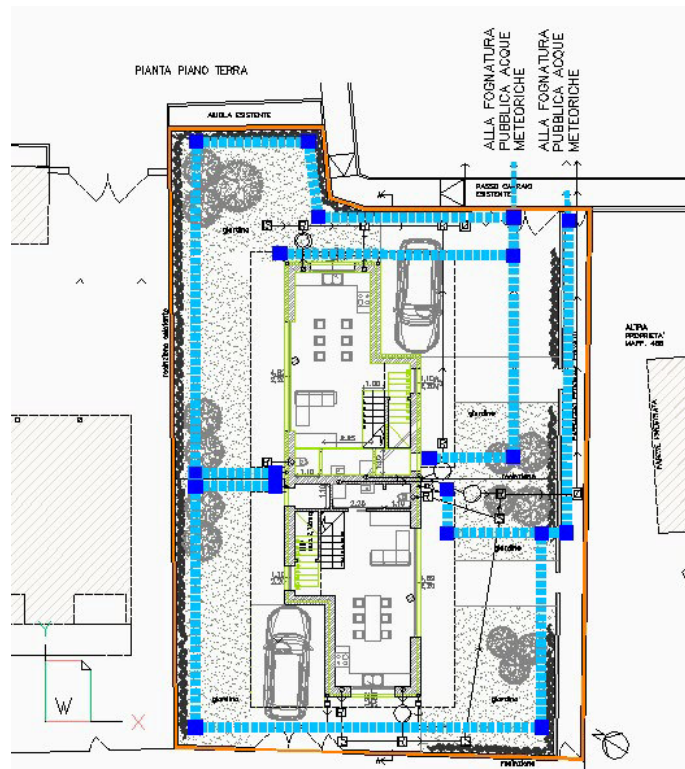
Planimetria di progetto (confine del lotto indicato con linea arancione)
